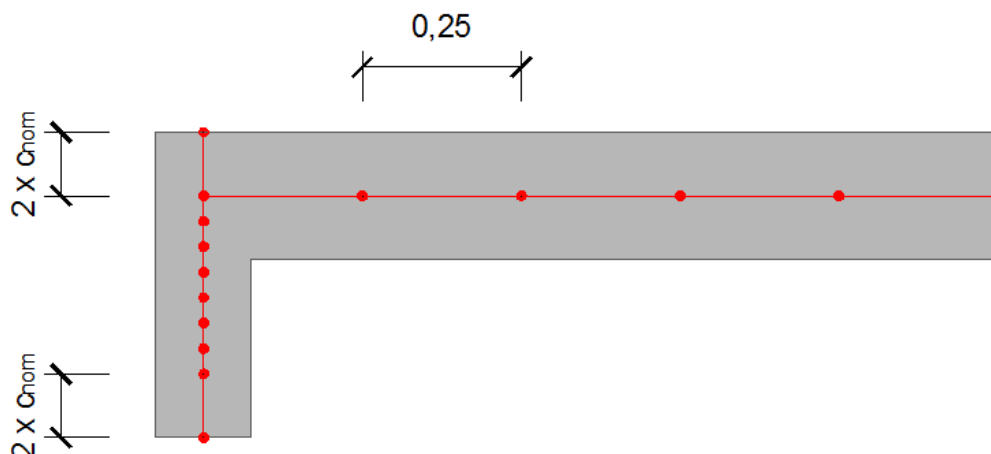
Esquema de ligação da viga à laje na malha de elementos finitos do modelo de viga
